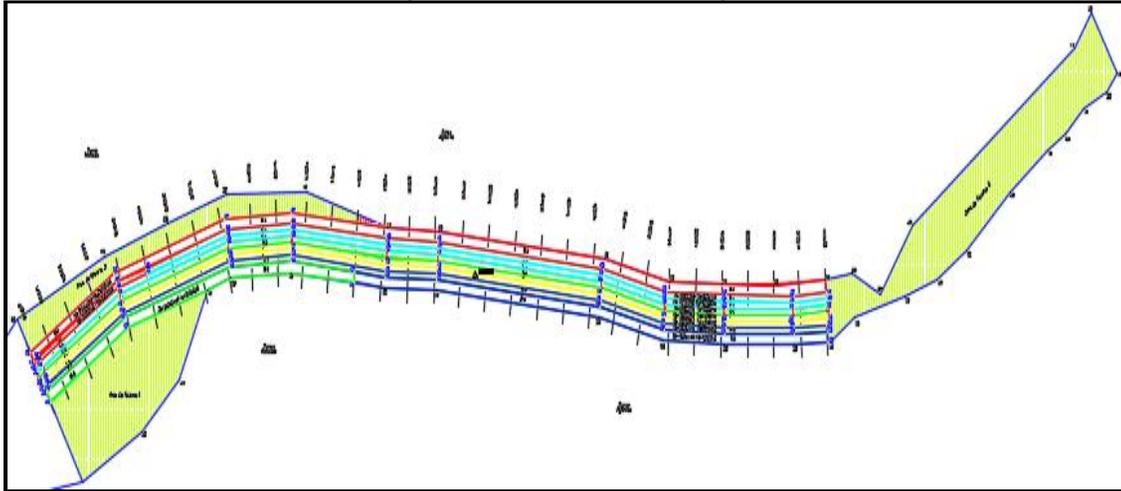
ZONA DE EXTRACCIÓN 2, 5 frentes de extracción divididos en 15 estaciones o secciones. (Plano Planta de extracción)
